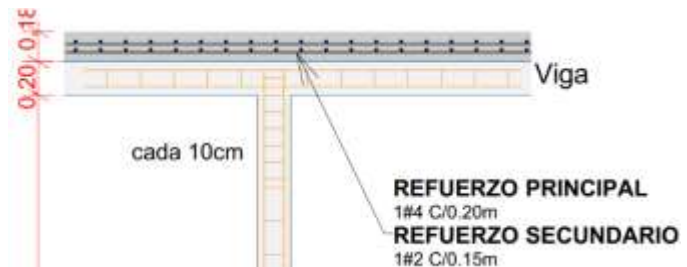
Detalle de placa entrepiso. Fuente: AutoCAD, elaboración propia.
